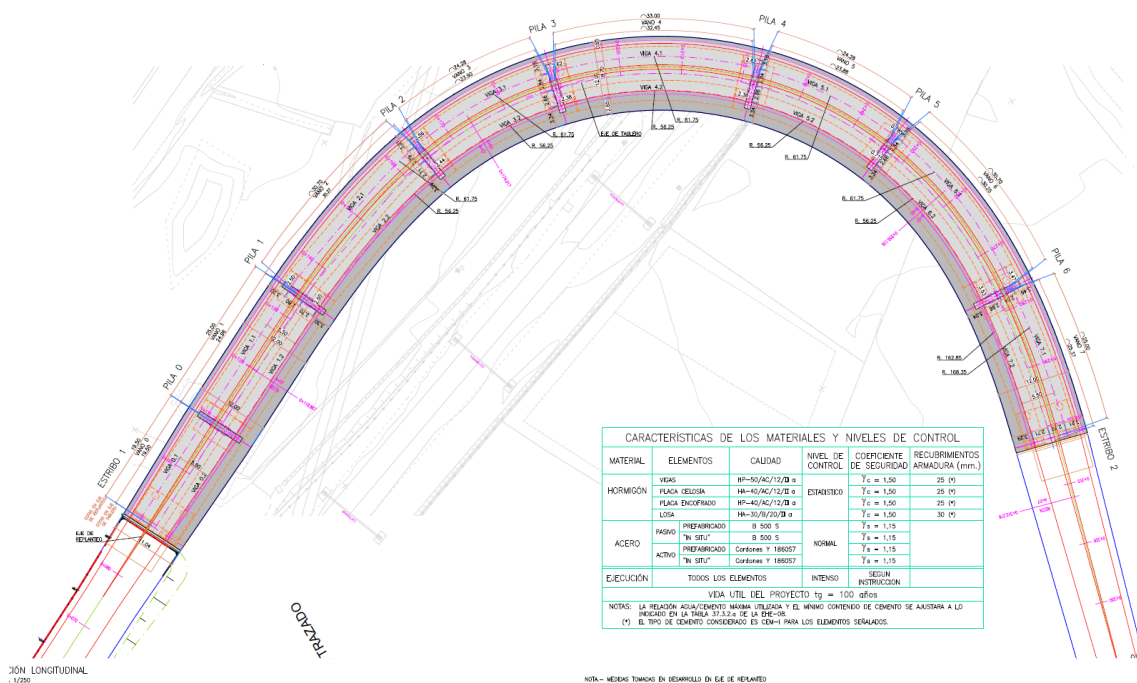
Planta de luces de las vigas prefabricadas hiperestáticas.
